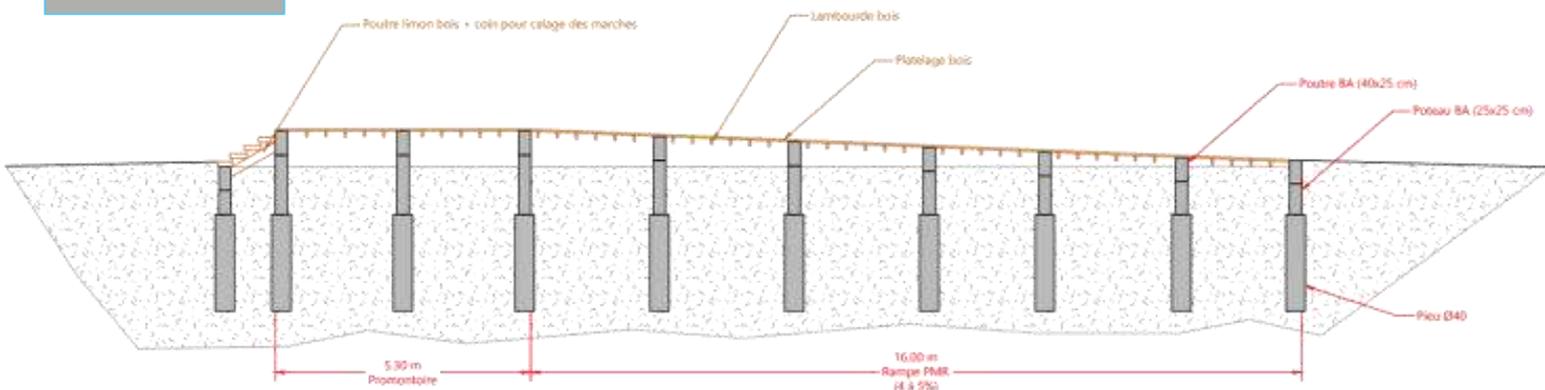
Schéma de principe – coupes projetées platelage sur pieux béton
